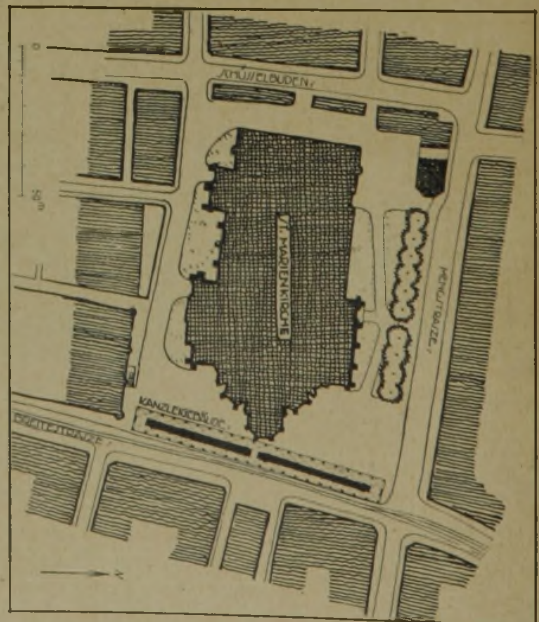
Lageplan des Kanzlei-Gebäudes.
